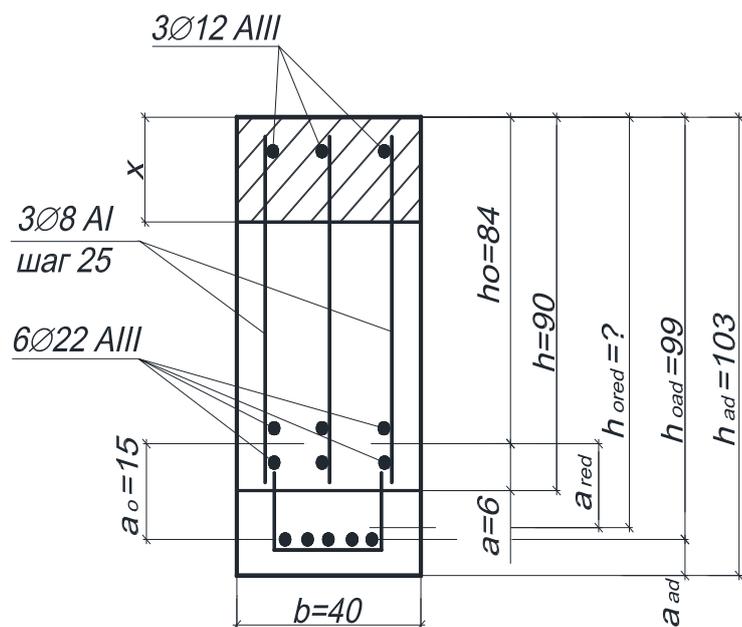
Расчетная схема усиления элементов прямоугольного профиля наращиванием снизу.
